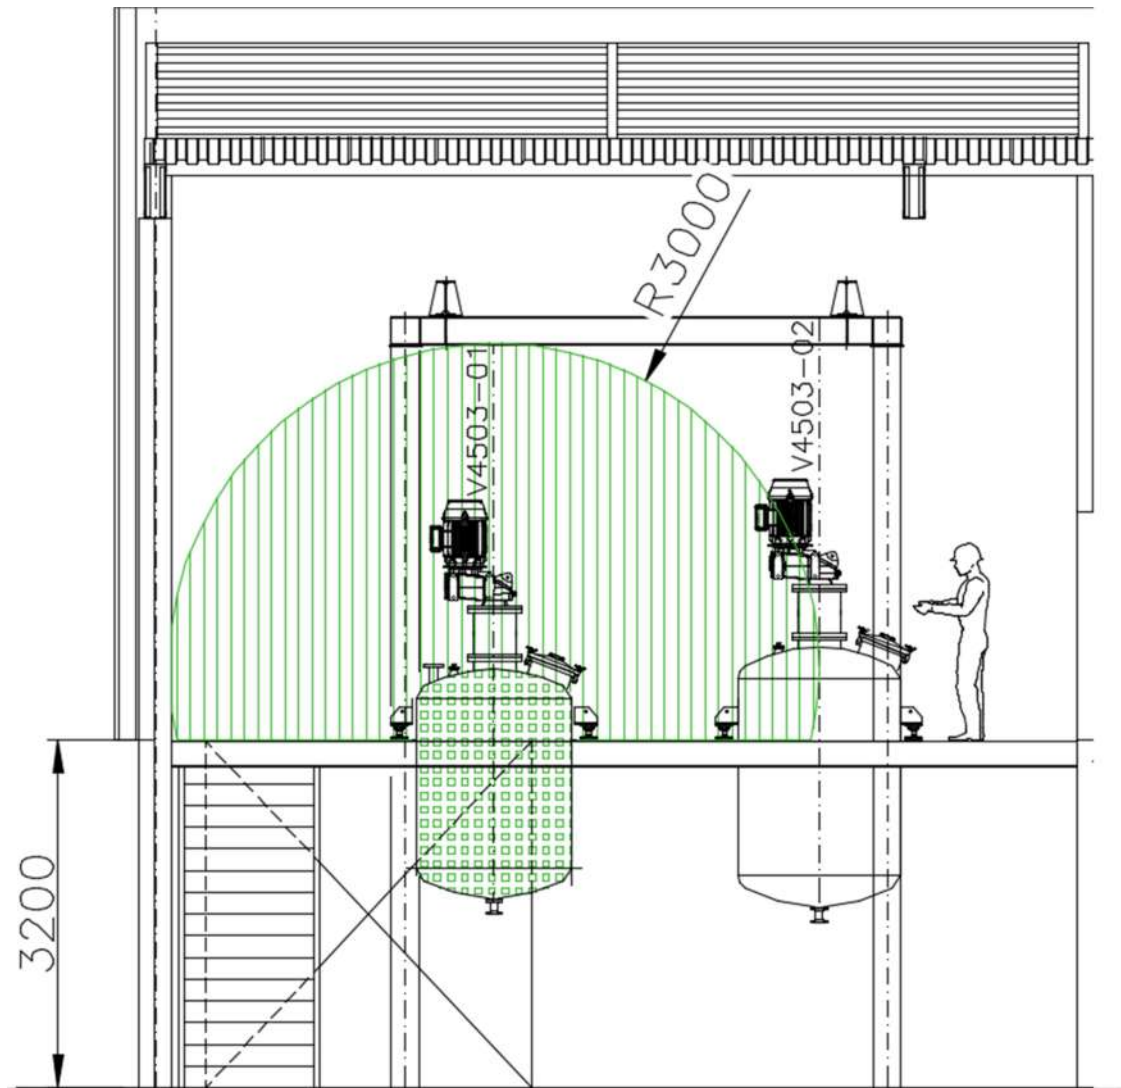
Planta de Classificação de Área- Vista frontal da planta de Vedantes
